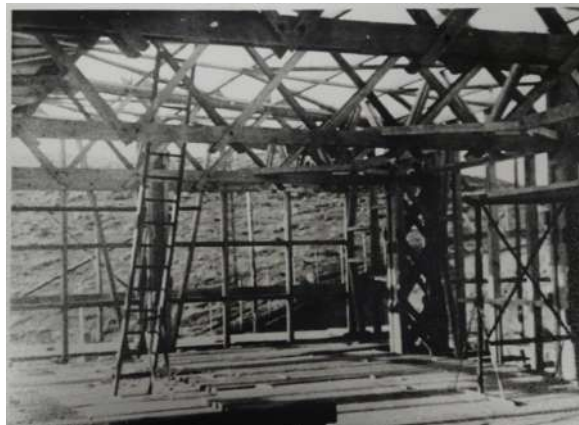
Construction d'une halle (?) (NATZ19_PH_ARCH_170, CERD).
